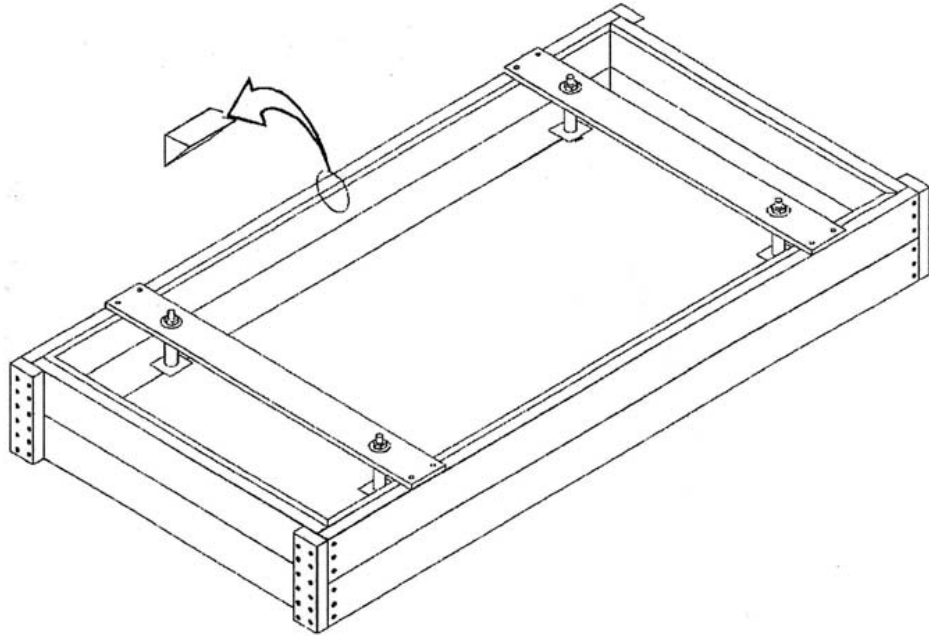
FORMA PARA LOSA DE CONCRETO
